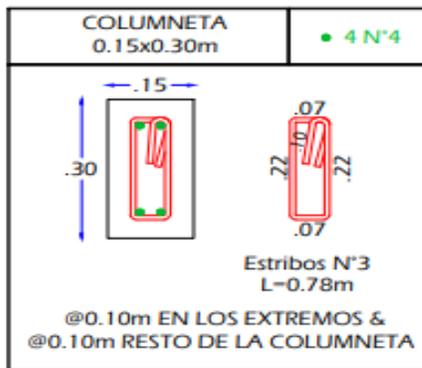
Despiece de estribo de columna 0.15x0.30.
